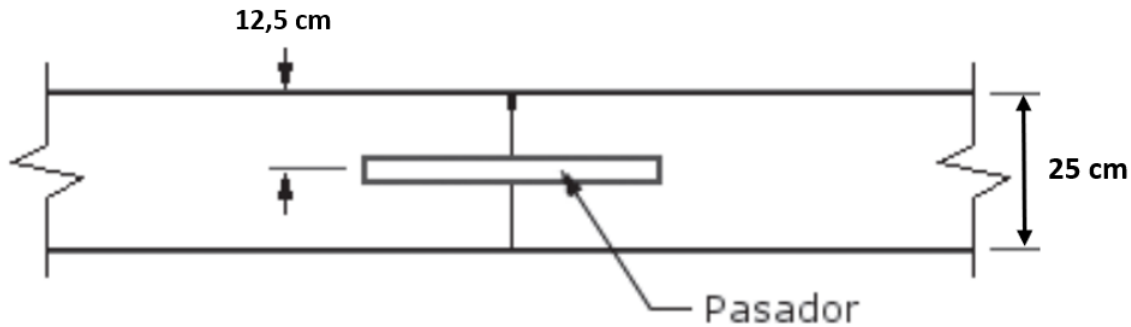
Junta transversal de construcción tipo B. Fuente: elaboración propia.
